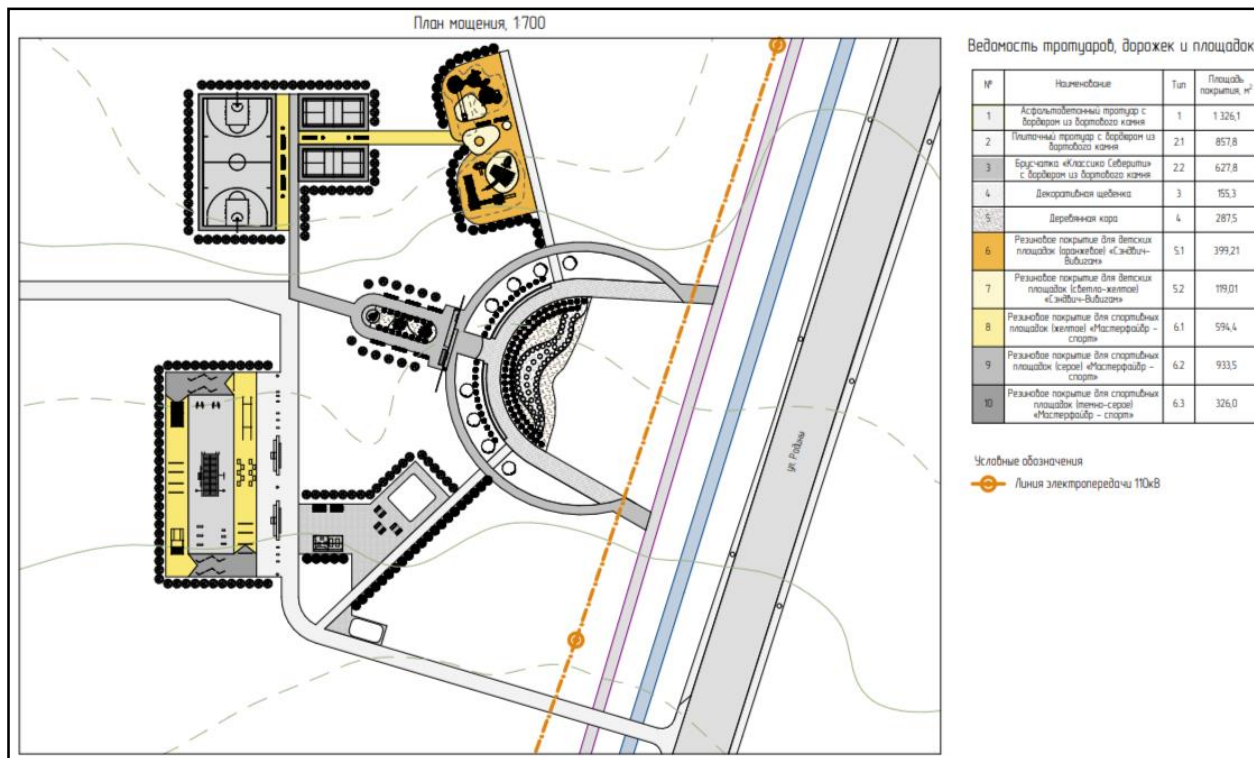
План мощения, ведомость тротуаров, дорожек и площадок
